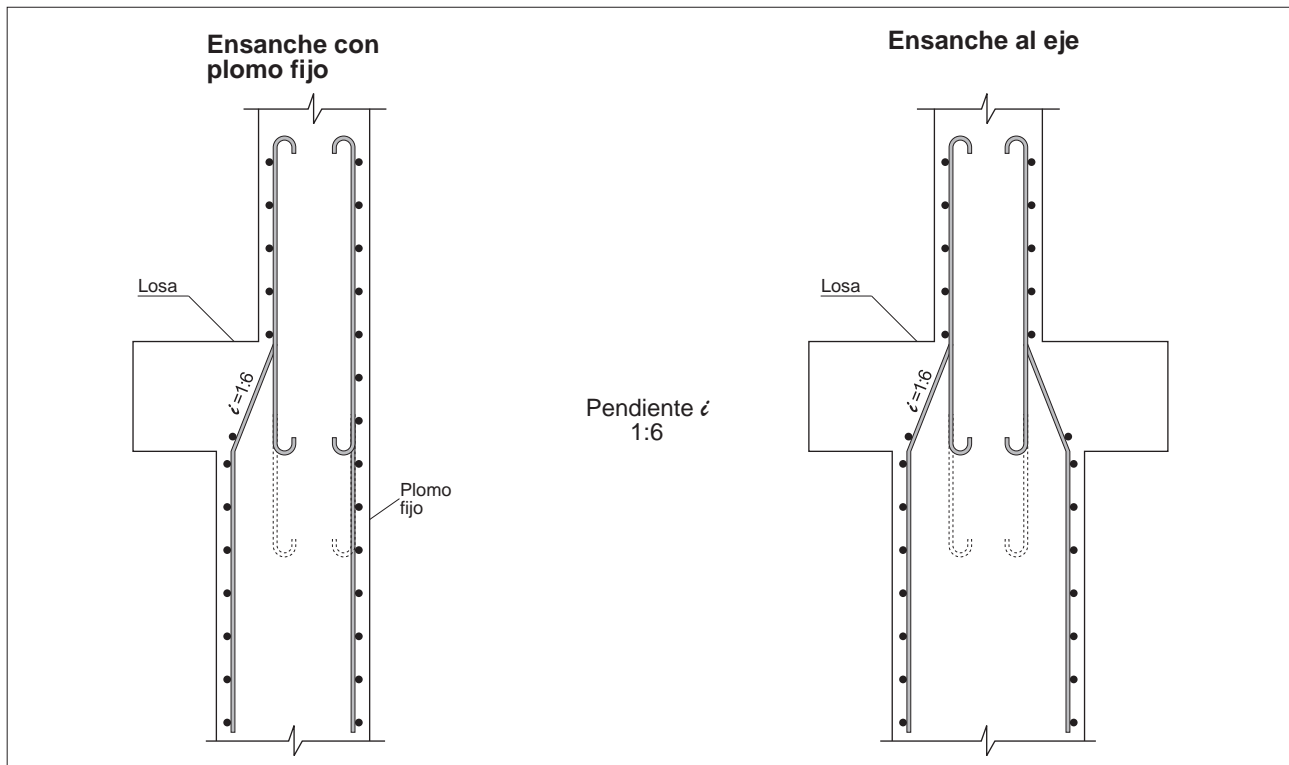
Ejemplo de Barras Longitudinales en una columna por cambio de sección.
